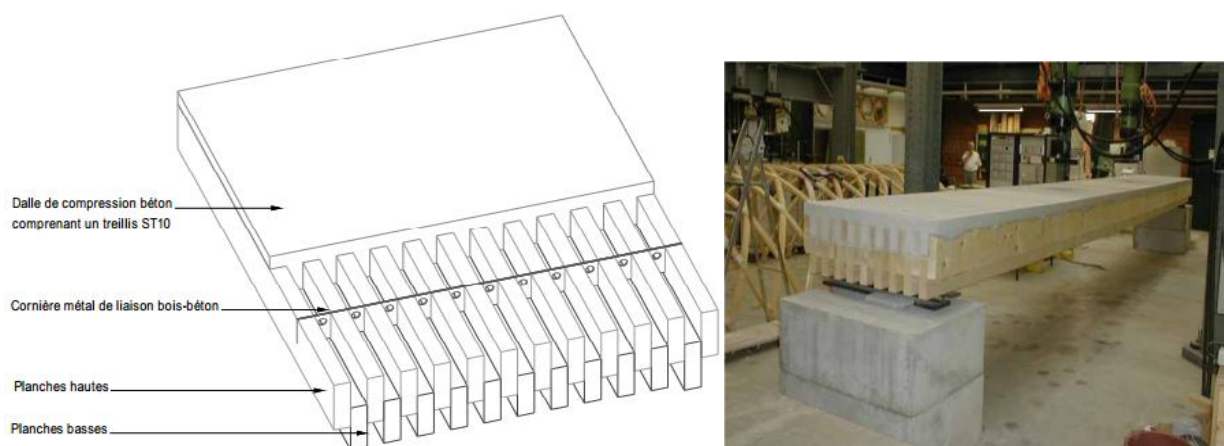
Schéma d'un plancher mixte D-Dalle.
